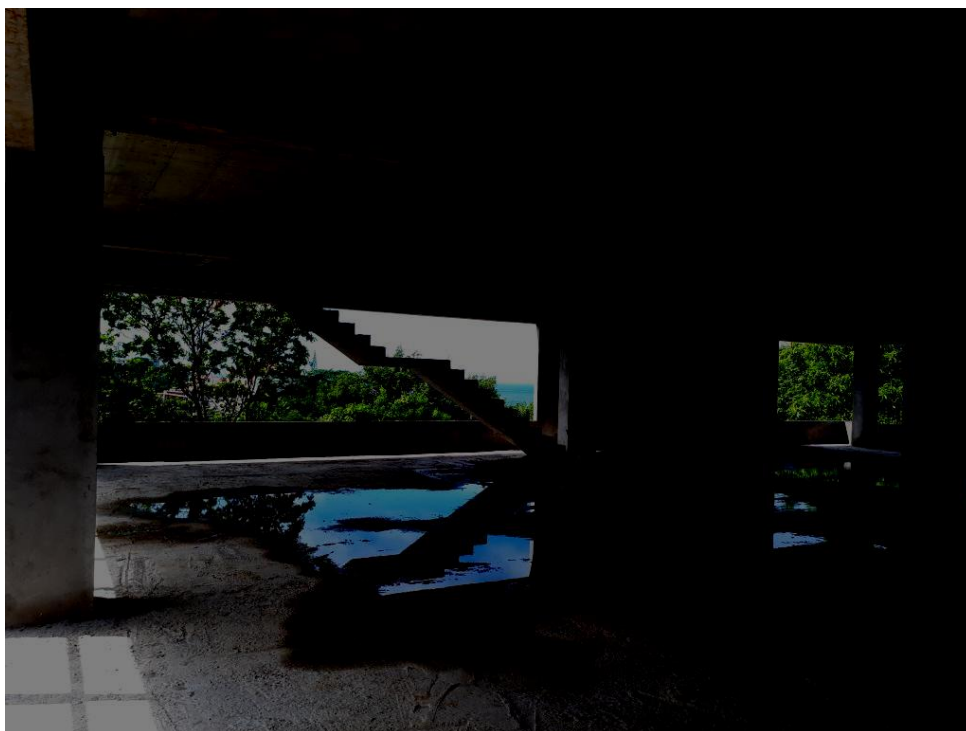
Vista da escada central concretada (térreo para o primeiro andar)
